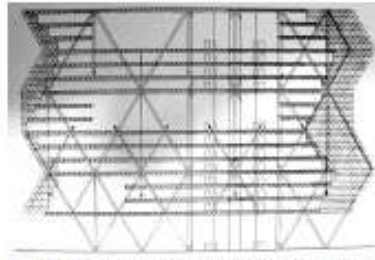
Sección estructural City Hall Tower 1953. Fuente, Kahn Collection, AAUP.
